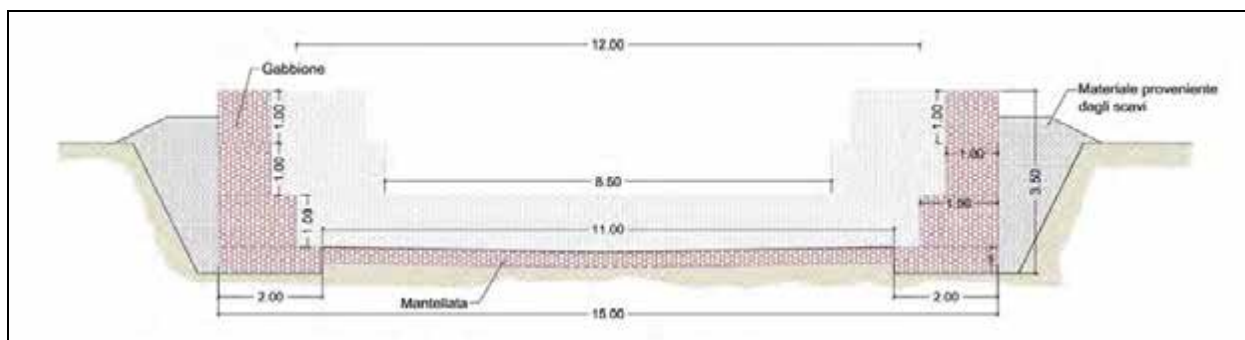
Sezione tipo (da sez. 5.4 a sez. 5.3)
